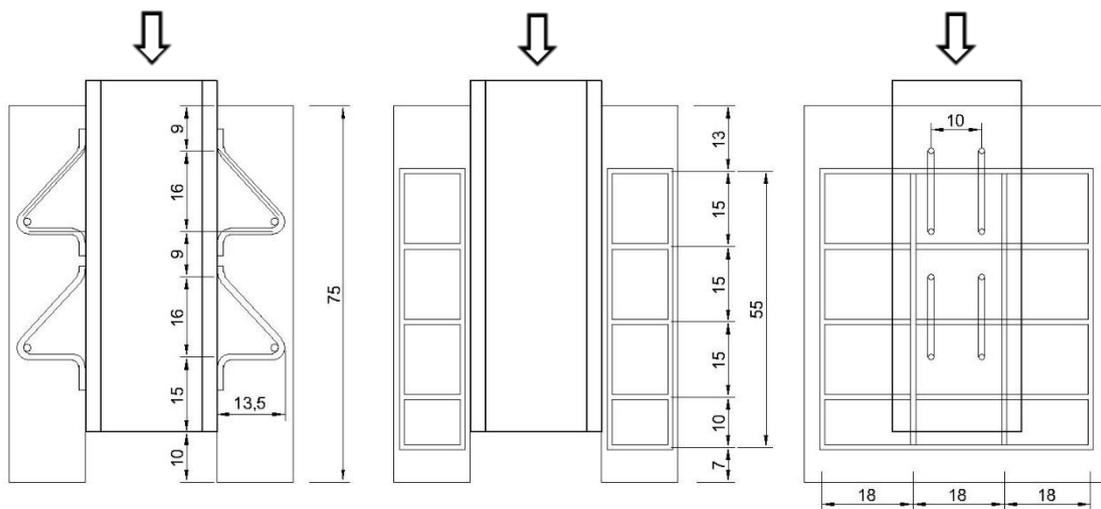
Posicionamento do conector e da armação da laje em relação ao perfil metálico.
